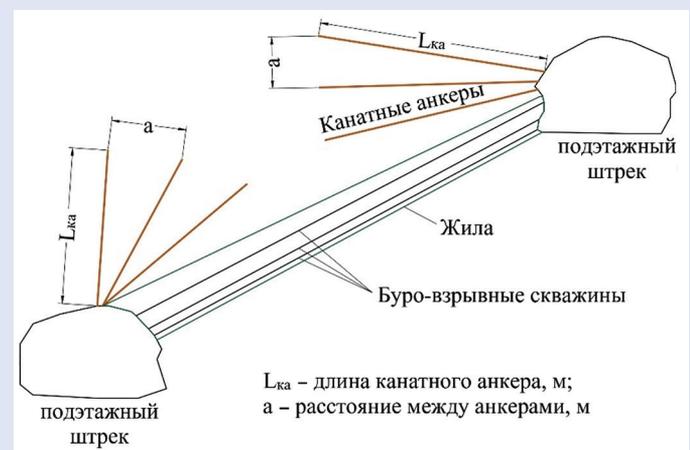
Схема крепления вмещающих пород кровли камеры канатными анкерами.
